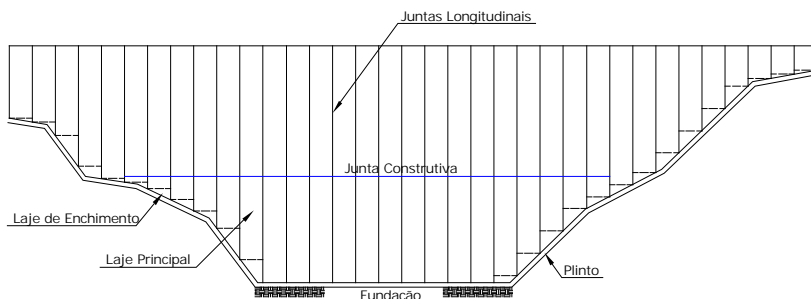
Vista geral da face de concreto de uma BEFC. Adaptado de Cruz (1996).
